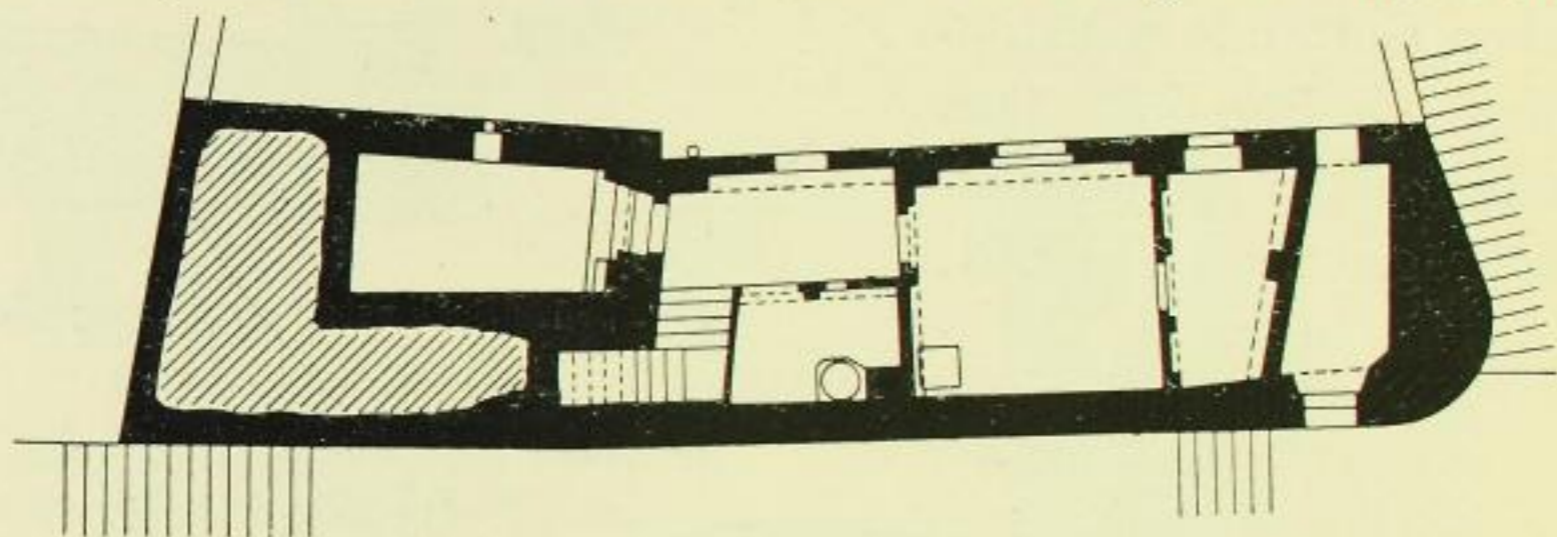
Seelensteg Nr. 2, Grundriß vom Erdgeschoß.
